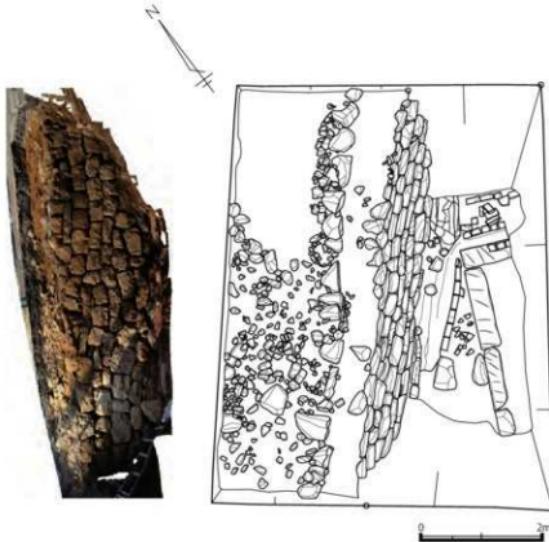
石垣 2 平面図及び立面オルソ図 (S=1/60)
